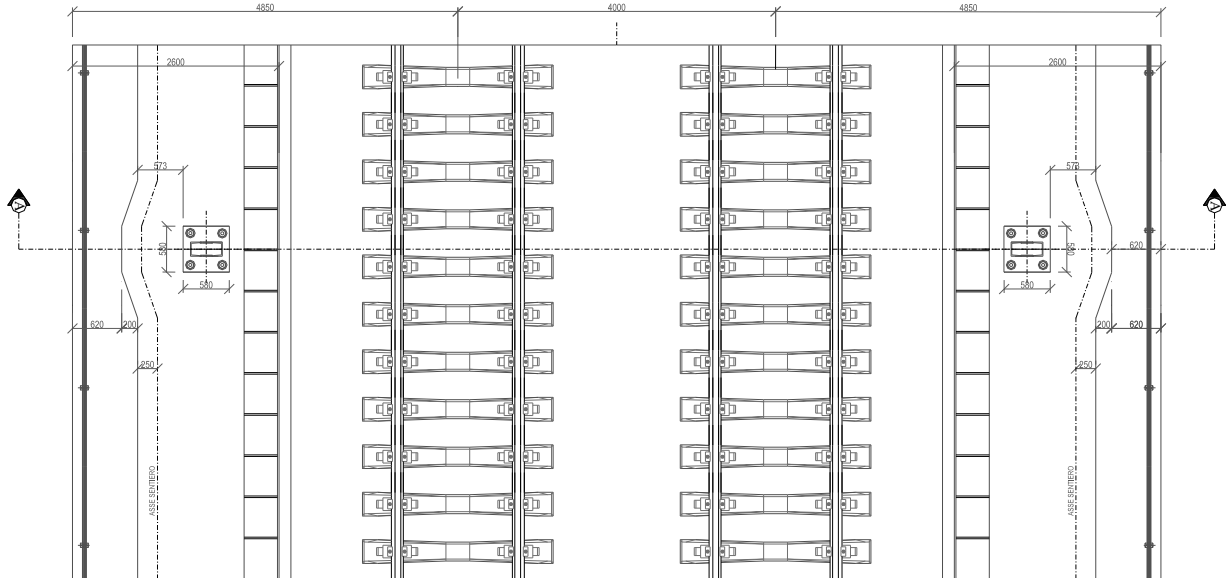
Stralcio planimetrico sezione tipo ferroviaria in viadotto a doppio binario
